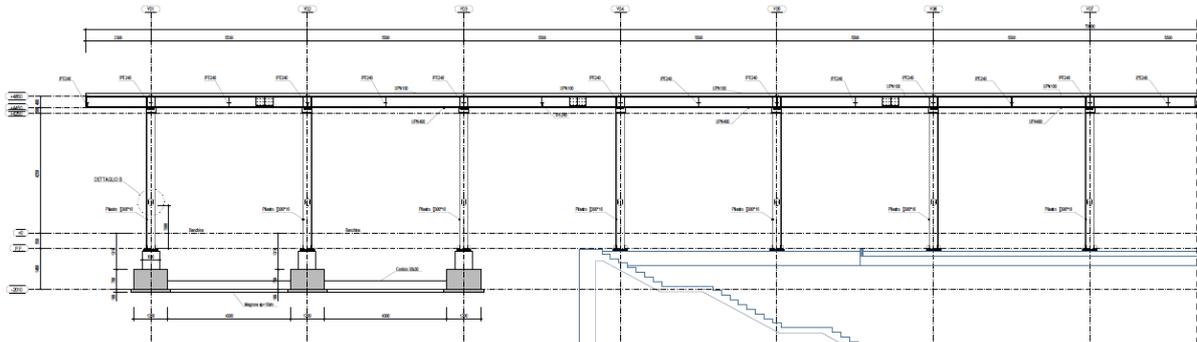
Pensiline - Stralcio sezione longitudinale Pensilina Sud
